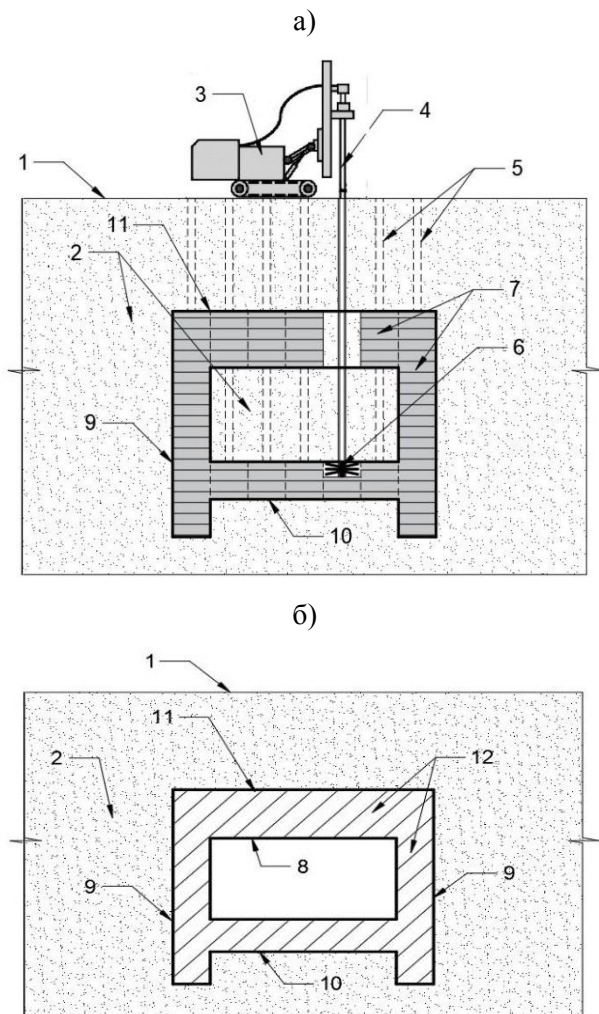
Схема зведення підземних споруд із ґрунтобетону:
